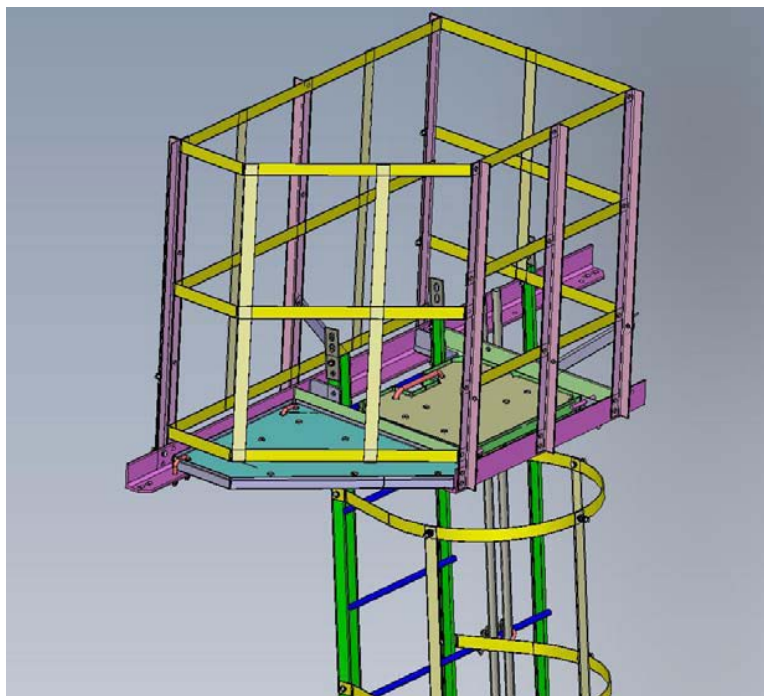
Площадка для отдыха, устанавливаемая каждые 8м по лестнице
